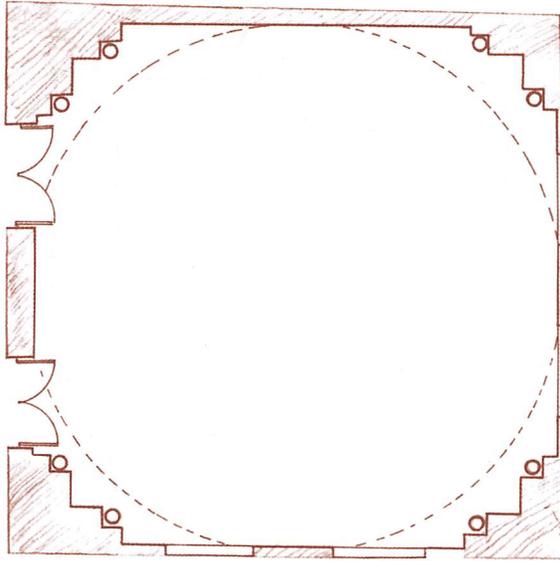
المسقط الأفقى لضريح الخراشى بدمنهور
